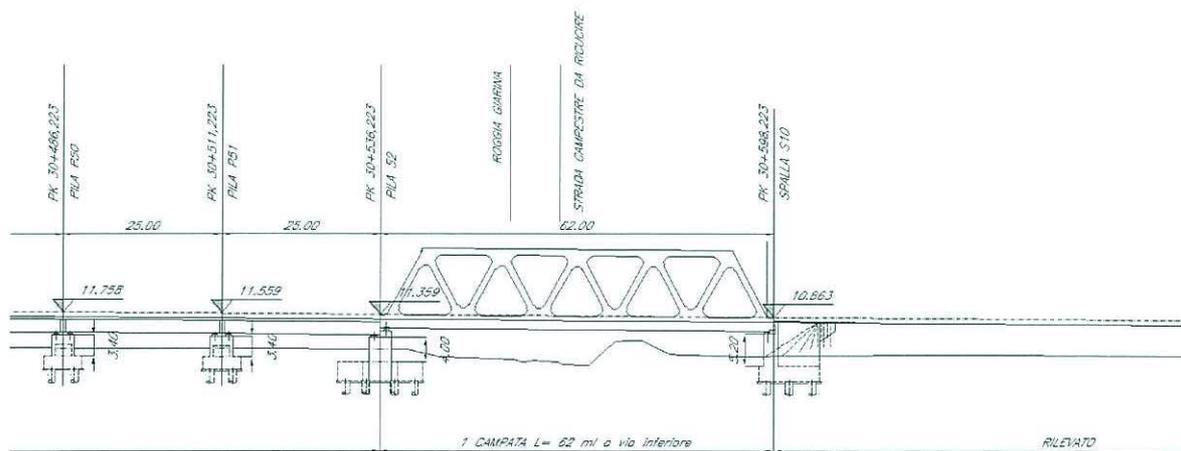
Prospetto dell'attraversamento della Roggia Giarina.
